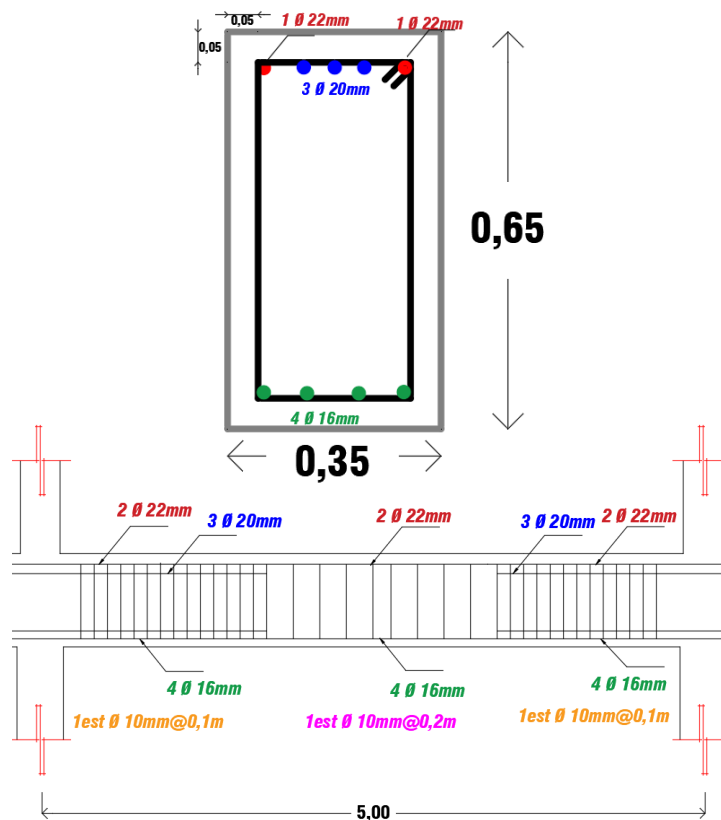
Detalle de la sección de acero de la viga crítica del sistema R=5
